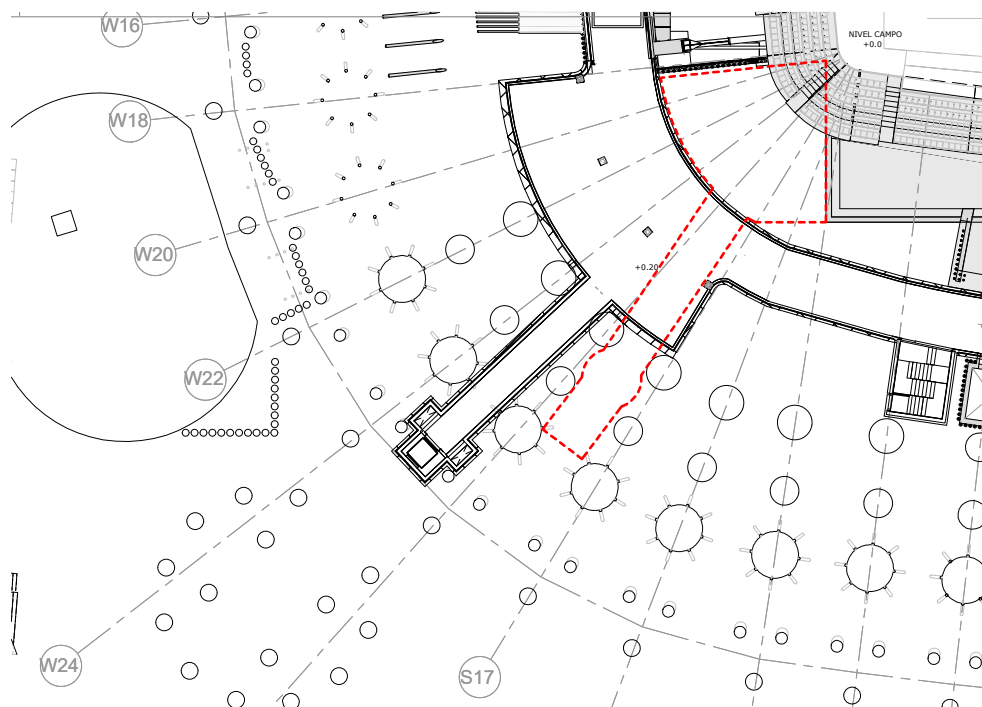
Planta general nivel de cimentación de toma de aire sur. El trazado del espacio para ventilación discurre bajo la galería técnica y se ajusta a la ubicación de la cimentación existente del lateral oeste del estadio.
